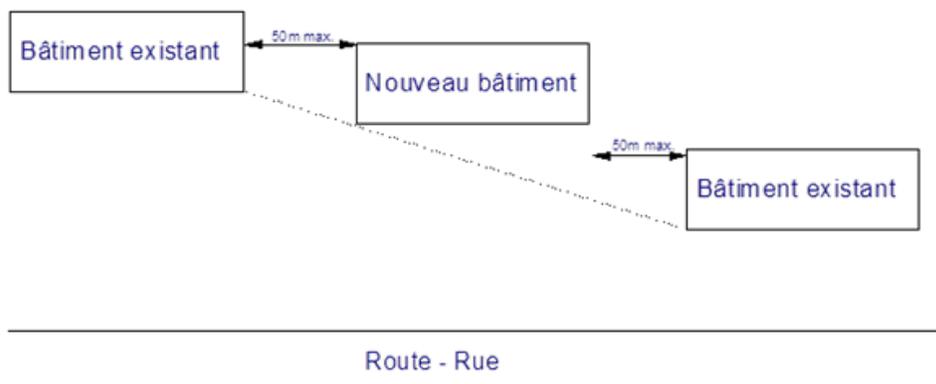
B : CONSTRUCTION ADJACENTE À UN TERRAIN CONSTRUIT
